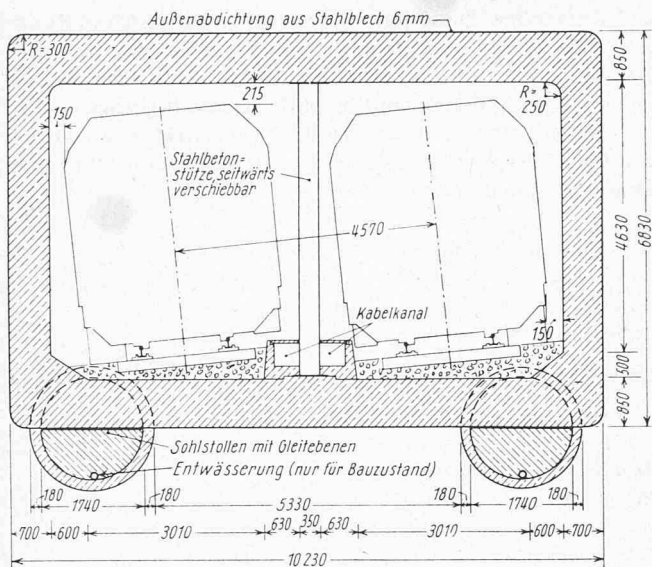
Querschnitt des fertigen Tunnels mit den beiden Sohlstollen. Masse in mm
